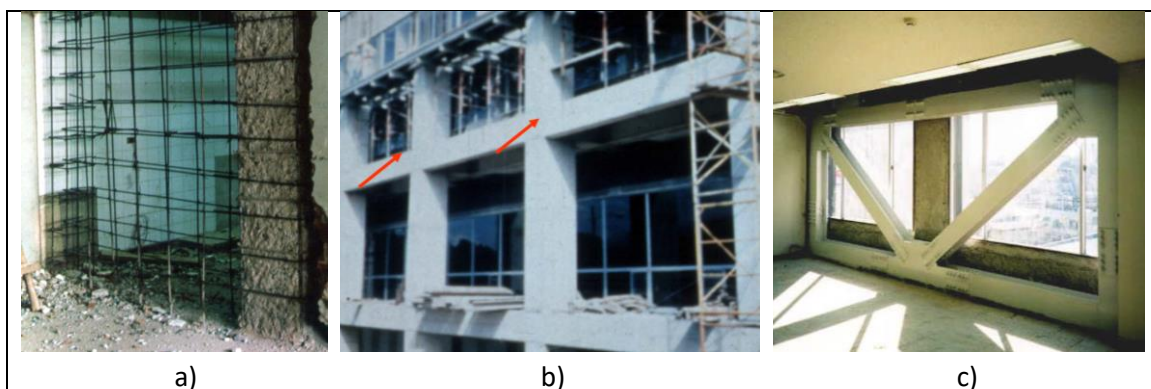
a) Inclusión muros de corte. b) Inclusión pórticos de concreto armado, c) Inclusión arriostres metálicos.
